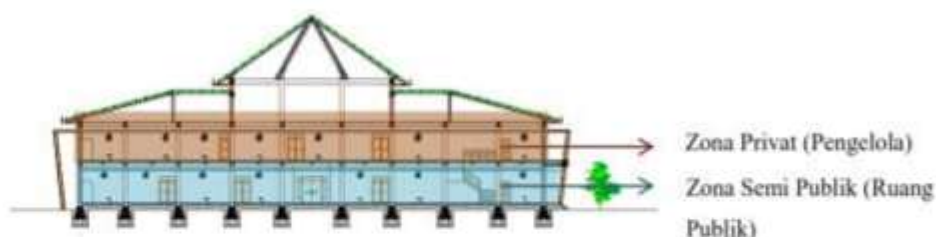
19 Konsep ruang bangunan utama secara horizontal
